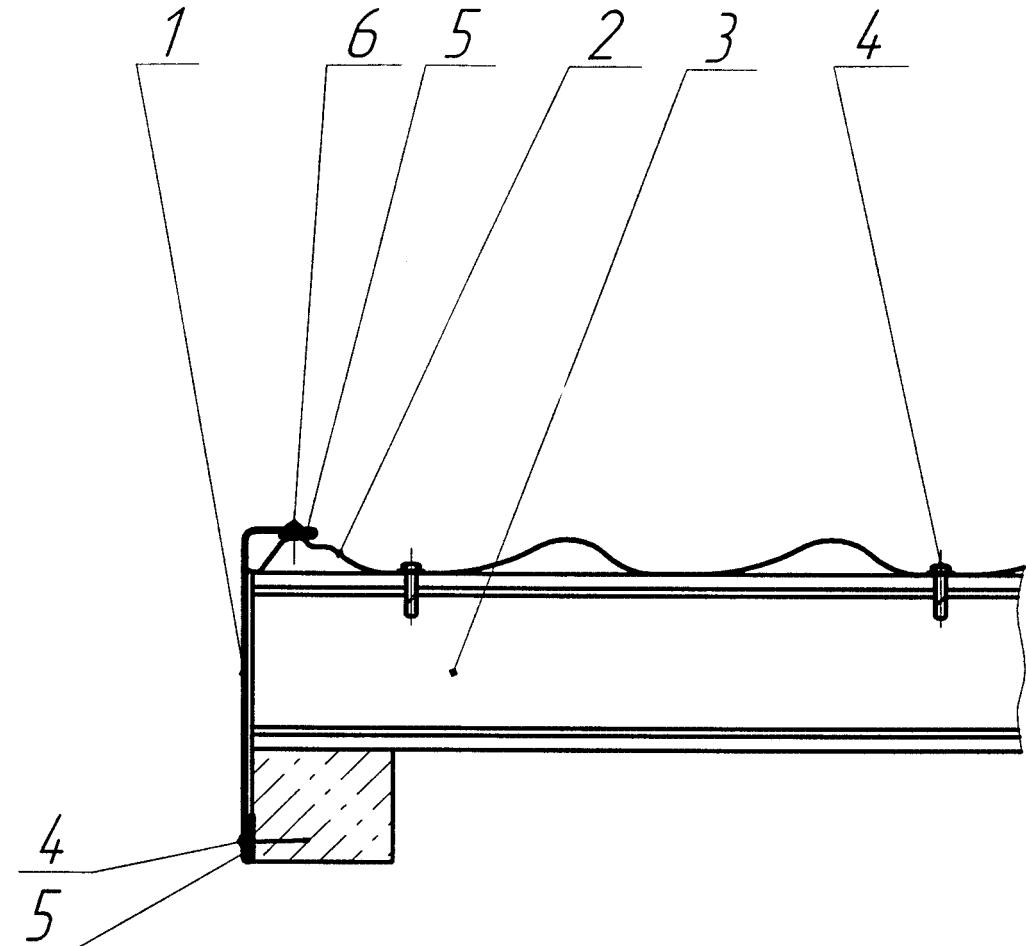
Установка накладки внутренней на стыке листов металлической черепицы
